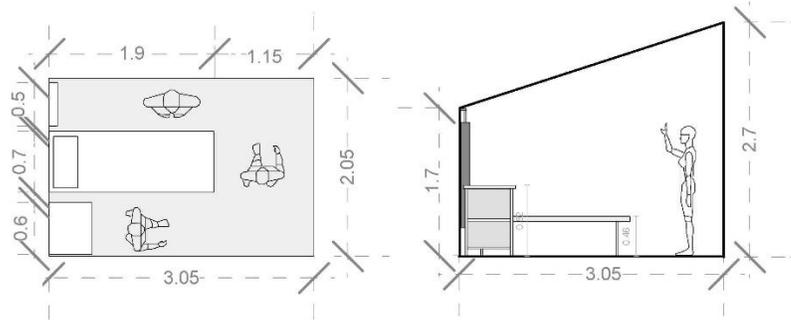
Distribución en planta y alzado de un módulo base para un paciente.
